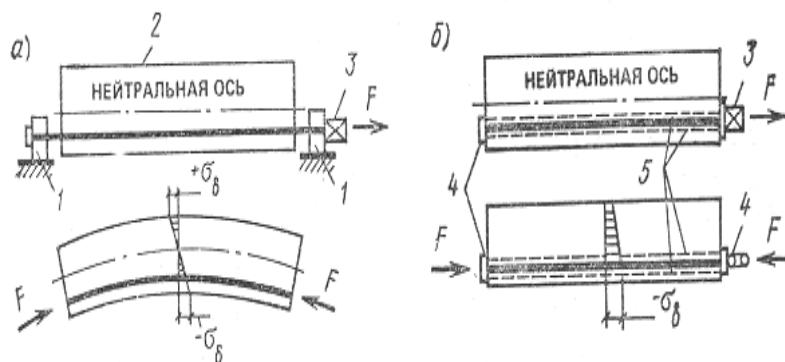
Схемы предварительного натяжения арматуры железобетонных конструкций.
